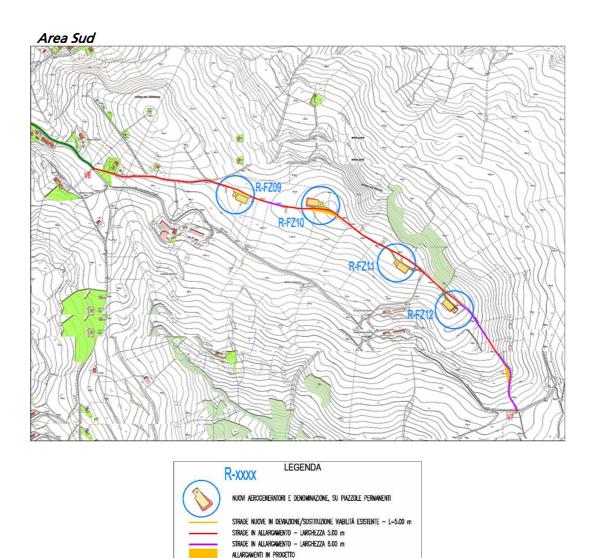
Stralci planimetrie d'impianto con viabilità di accesso agli aerogeneratori
